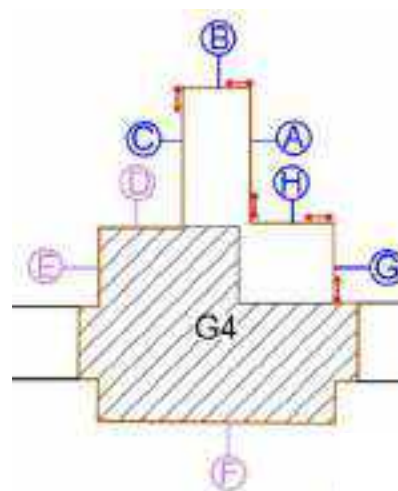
Planimetria con ubicazione delle aree di indagine
